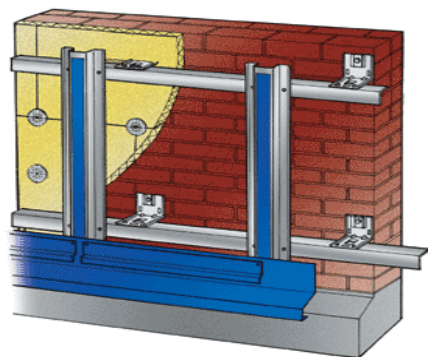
Монтаж цокольного отлива и начальной планки
